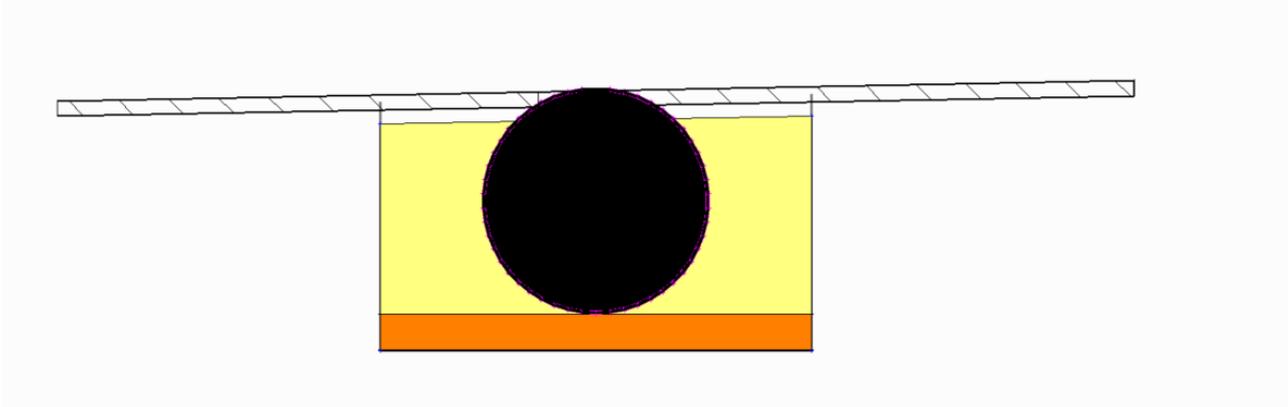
Coupe de la traversée de la conduite existante au-dessous de la chaussée projetée
